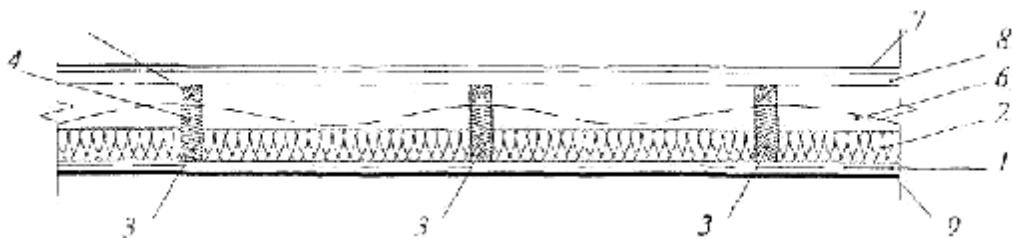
Кровельный «пирог»: 7 — пароизоляция; 2 — утеплитель; 3 — стропила; 4 — промежуточная обрешетка; 5 — контробрешетка; 6 — гидроизоляция; 7 — профнастил; 8 — обрешетка; 9 — потолок
